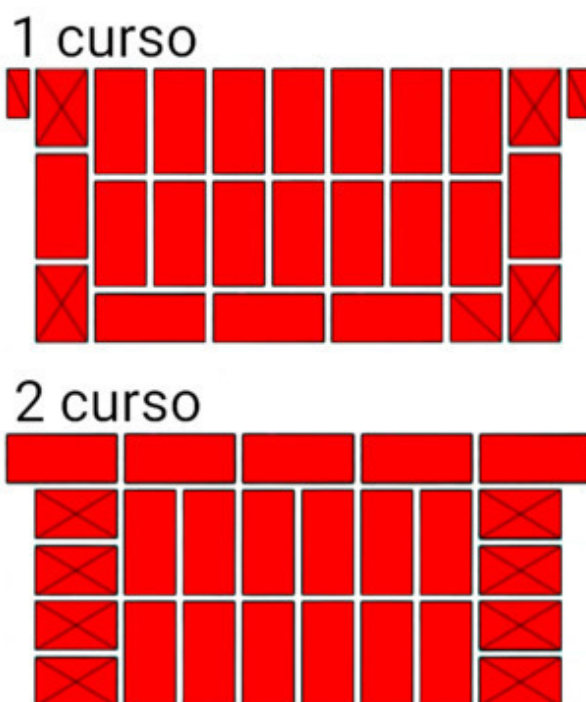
A ordem de colocar tijolos em uma seção de paredes entre as aberturas das janelas. Espessura da parede 2,5 tijolos.
